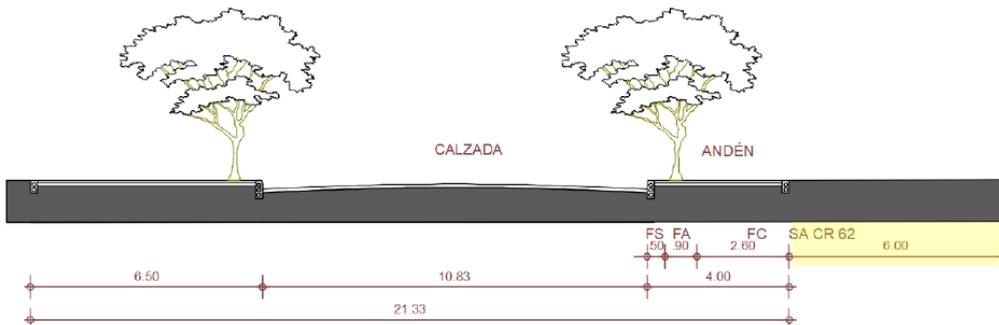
Secciones viales perimetrales con sobreanchos de andenes previstos por el PPRU Textilia
